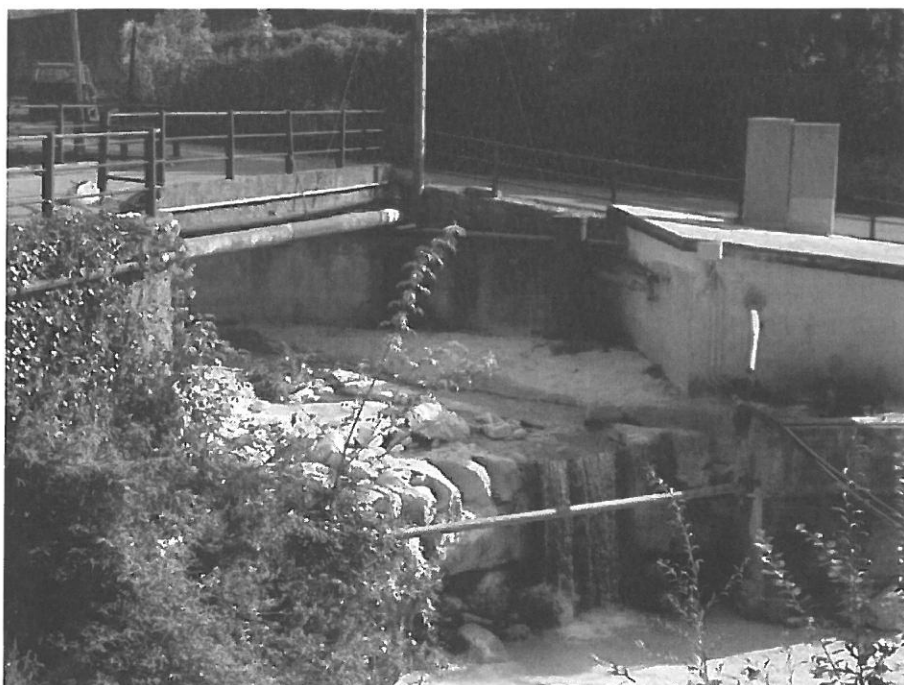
Settore 6 – tratto a monte della briglia di sezione n.25 da adeguare idraulicamente.
